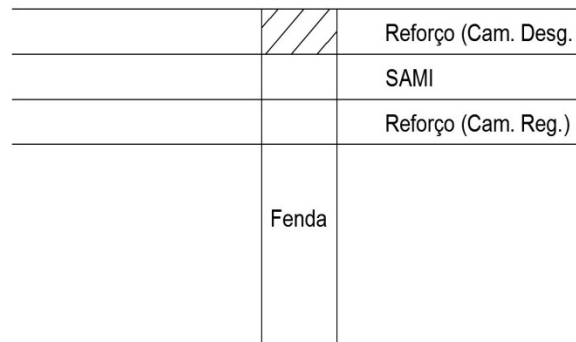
Representação das camadas a analisar acima da fenda – pavimento flexível
